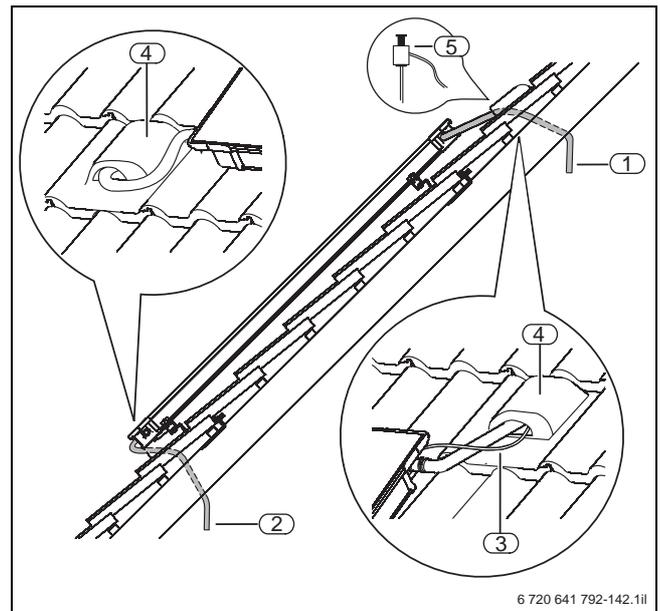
Sistemazione delle condutture di allacciamento sotto il tetto
